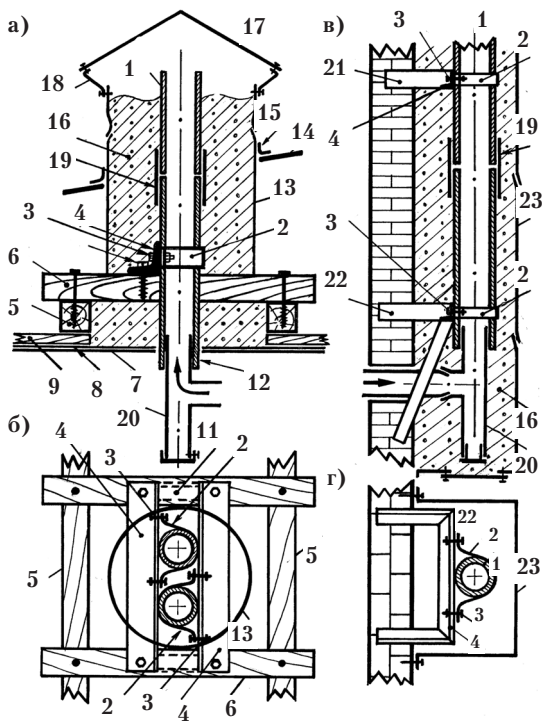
Конструкция утеплённой асбестоцементной трубы: а – труба, закреплённая на перекрытии (вид сбоку), б – то же, вид сверху, в – труба, закреплённая на каменной стене здания (вид сбоку), г – то же, вид сверху.
